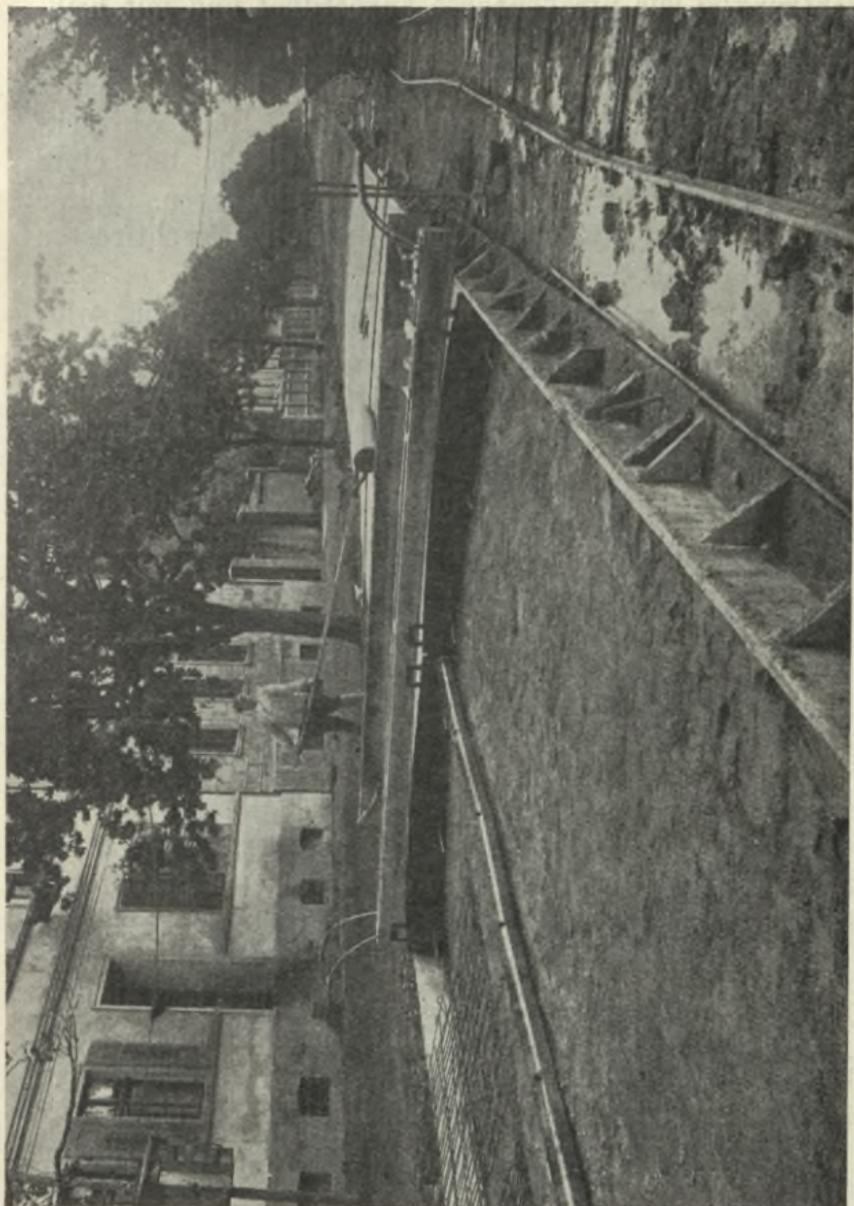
Betonversuchsstraße Groß-Salze-Felgeleben (1925). Stampfen und Glätten des Betons.
